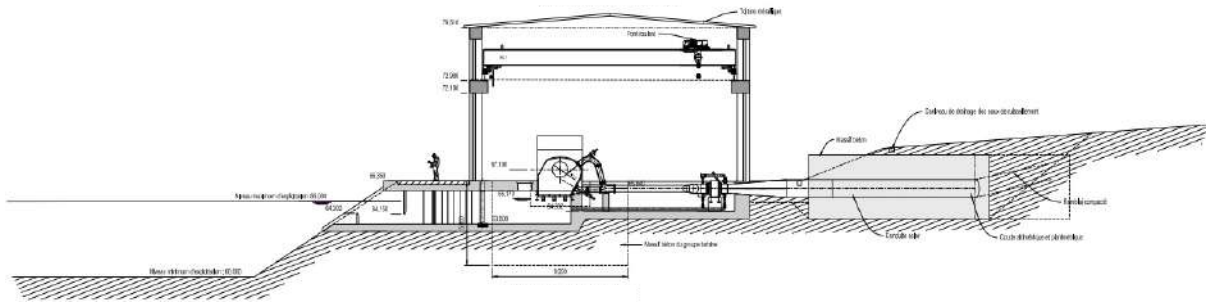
Coupe transversale de l'usine (source : ISL Ingénierie)
